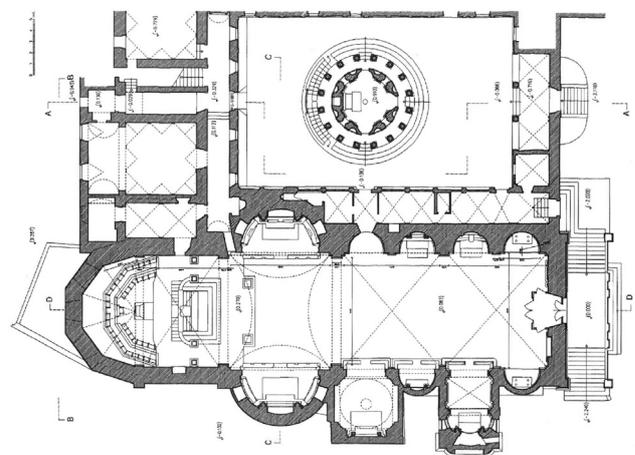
Chiesa di San Pietro in Montorio. Planta Baja. (levantamiento de Flavia Cantatore)
